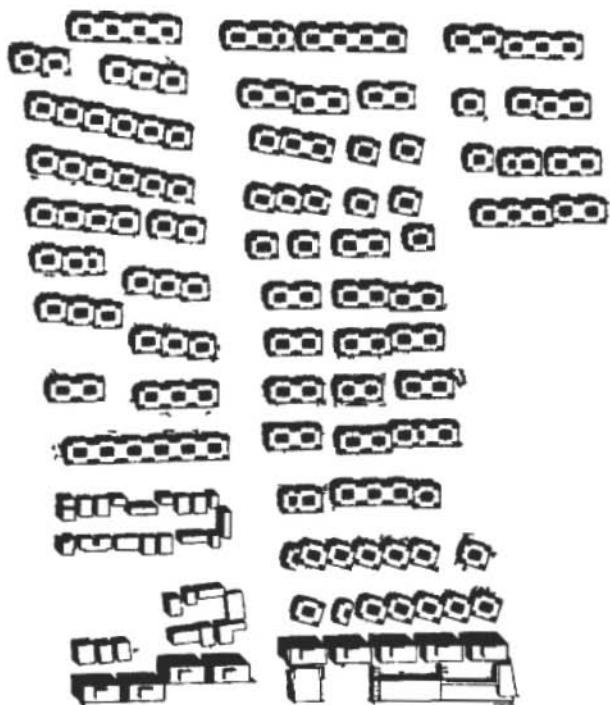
Planta de conjunto de la colonia del Parque .
